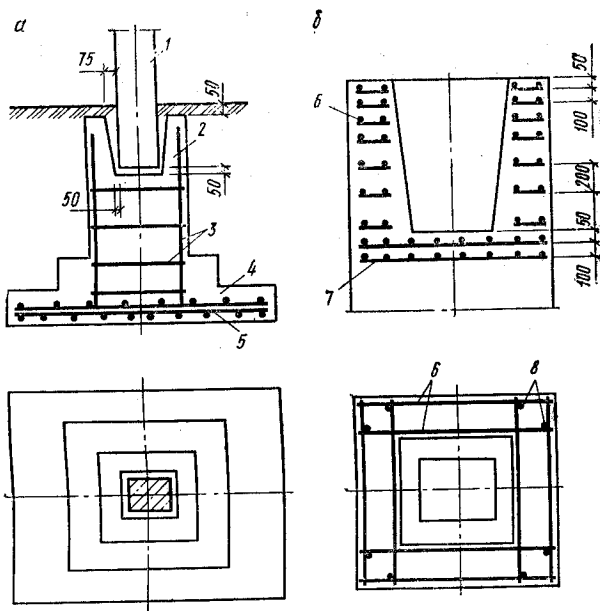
Монолитный отдельный фундамент, сопрягаемый со сборной колонной
